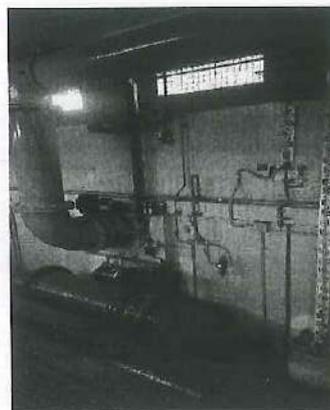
Vista de los componentes del sistema de inyección de aire comprimido y bombeo de agua filtrada en la Planta N° 01.
